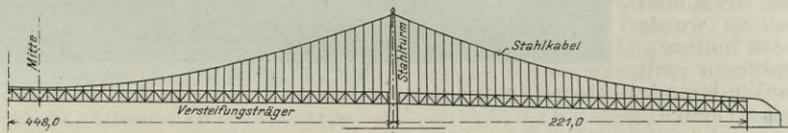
Halbes Tragwerk der Manhattan-Brücke in New York (Versteifte Kabelbrücke).
